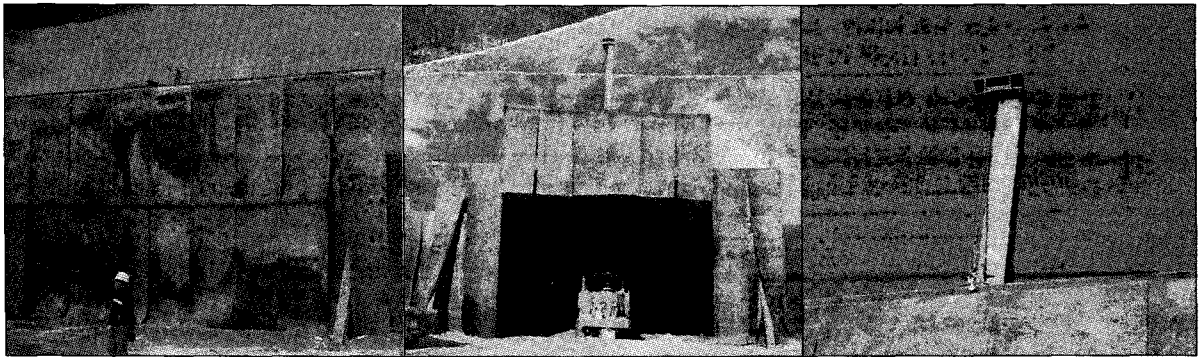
터널 갱구부에 설치된 Open Tunnel의 모습
